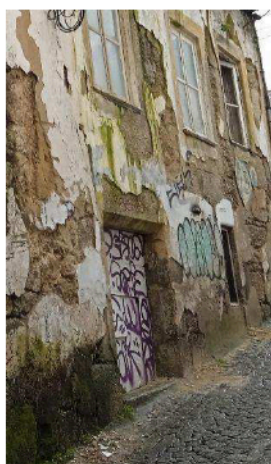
Pormenor de vão biselado, característico do século XVI e XVII.
